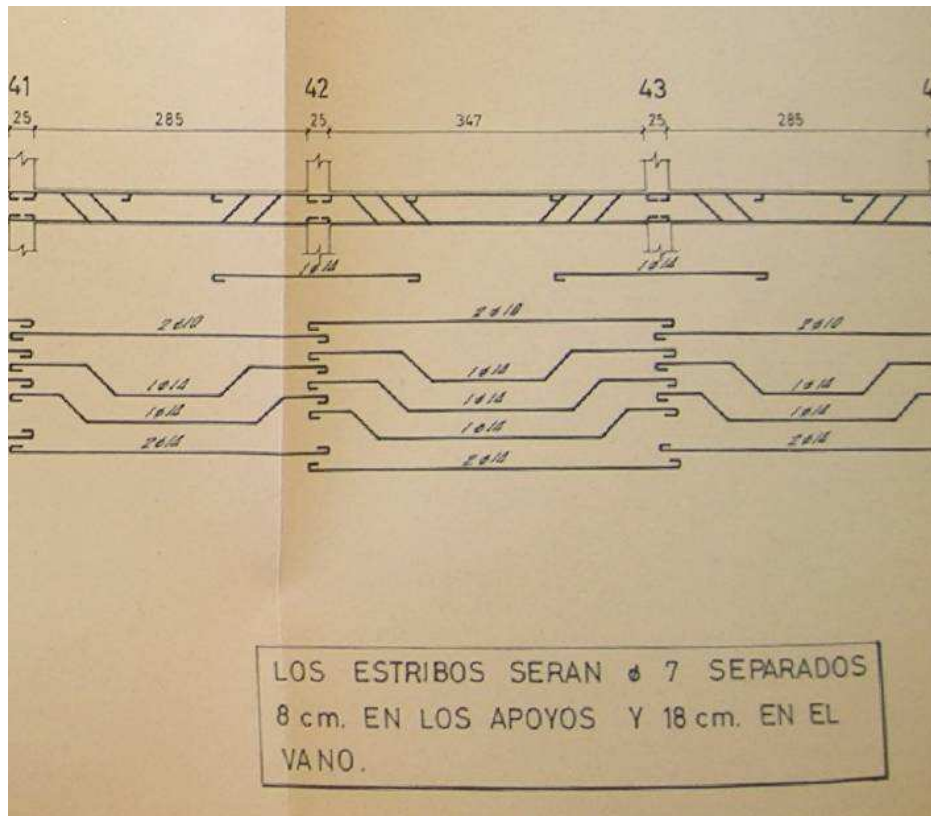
Despiece armado de viga. Edificio ficha 90C.003, 1966.
